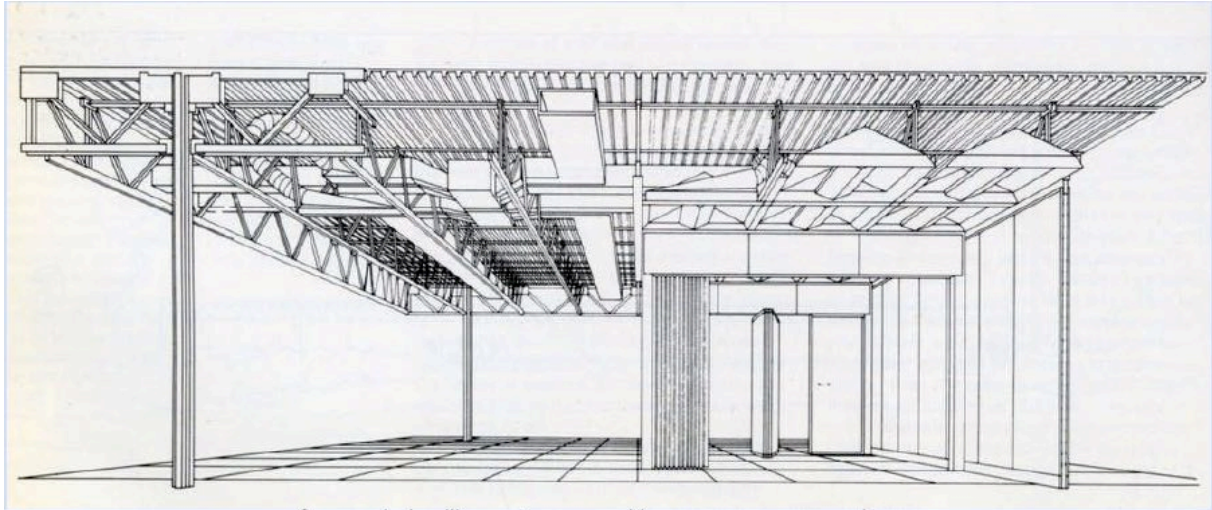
Vista prospettica del sistema strutturale-impiantistico dell'edificio modello del S.C.S.D. a Palo Alto, 1962.
